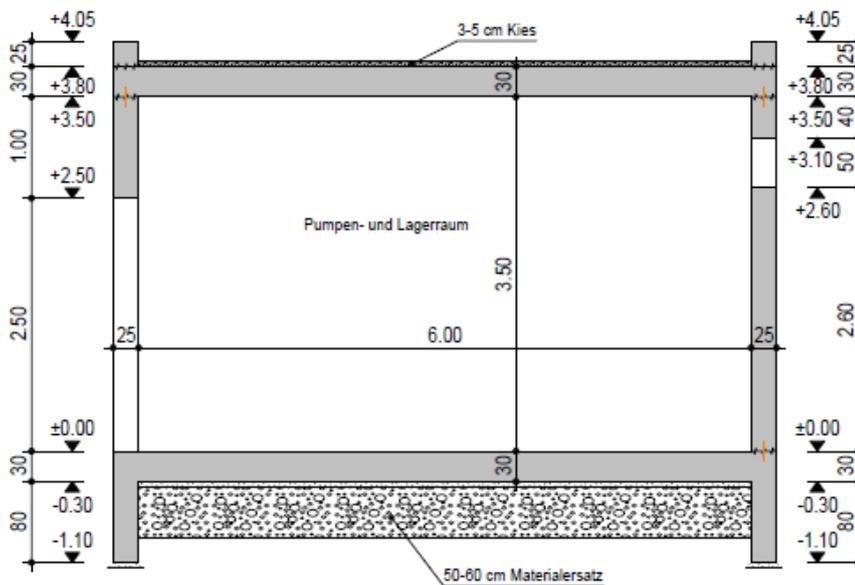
; Planausschnitt Querschnitt PS 200 (Pumpenraum / Lagerraum)
